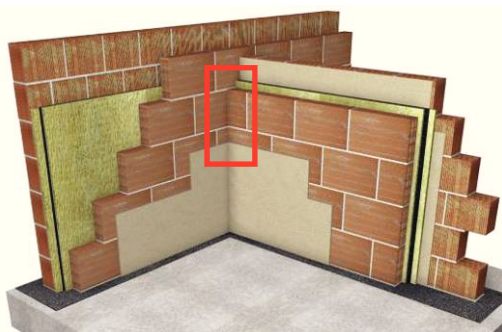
esempio di errata progettazione – parete esterna non interrotta in corrispondenza del giunto con la parete divisoria [43]
